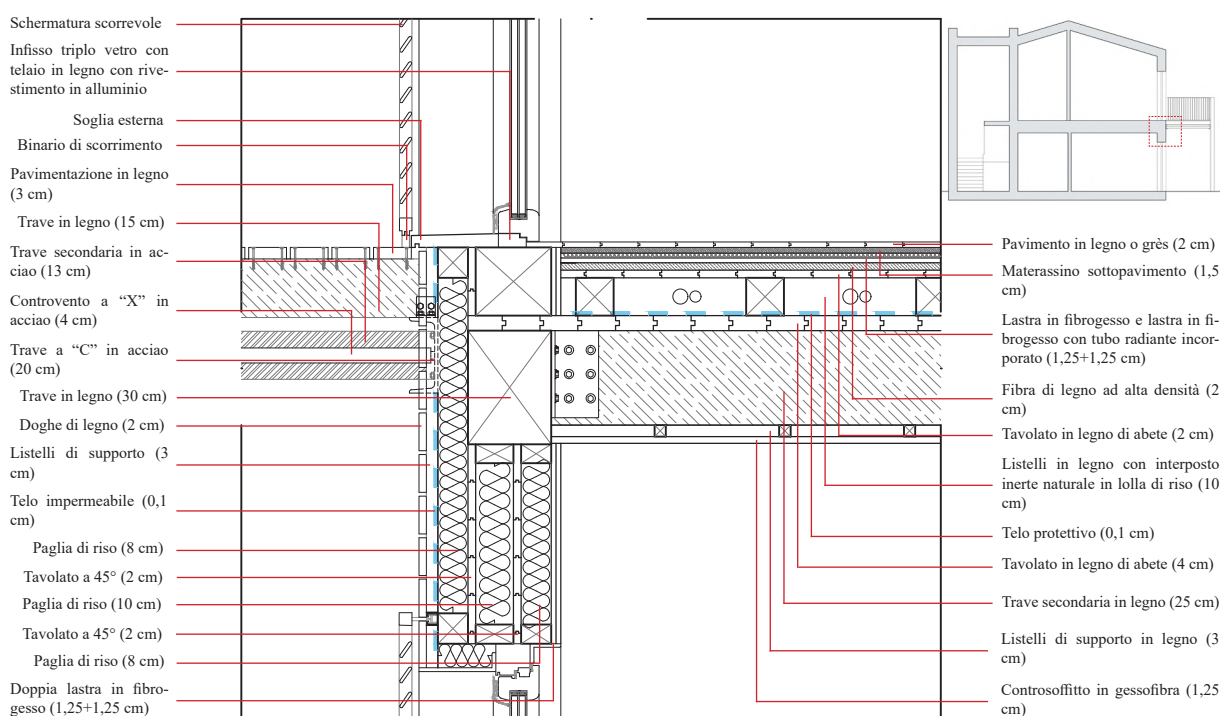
Nodo solaio interpiano - parete perimetrale - balconata esterna (scala 1:20)
